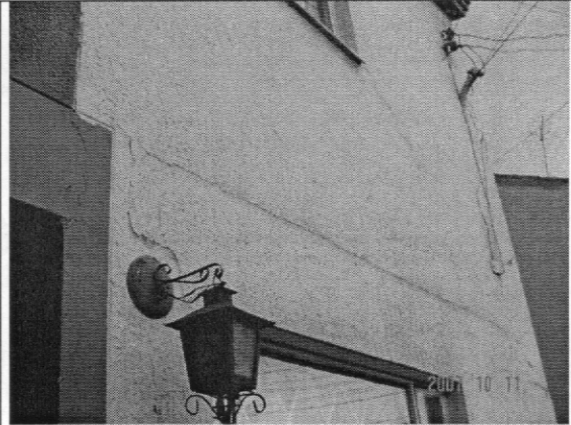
Muros externos con algunas fisuras en acabados
